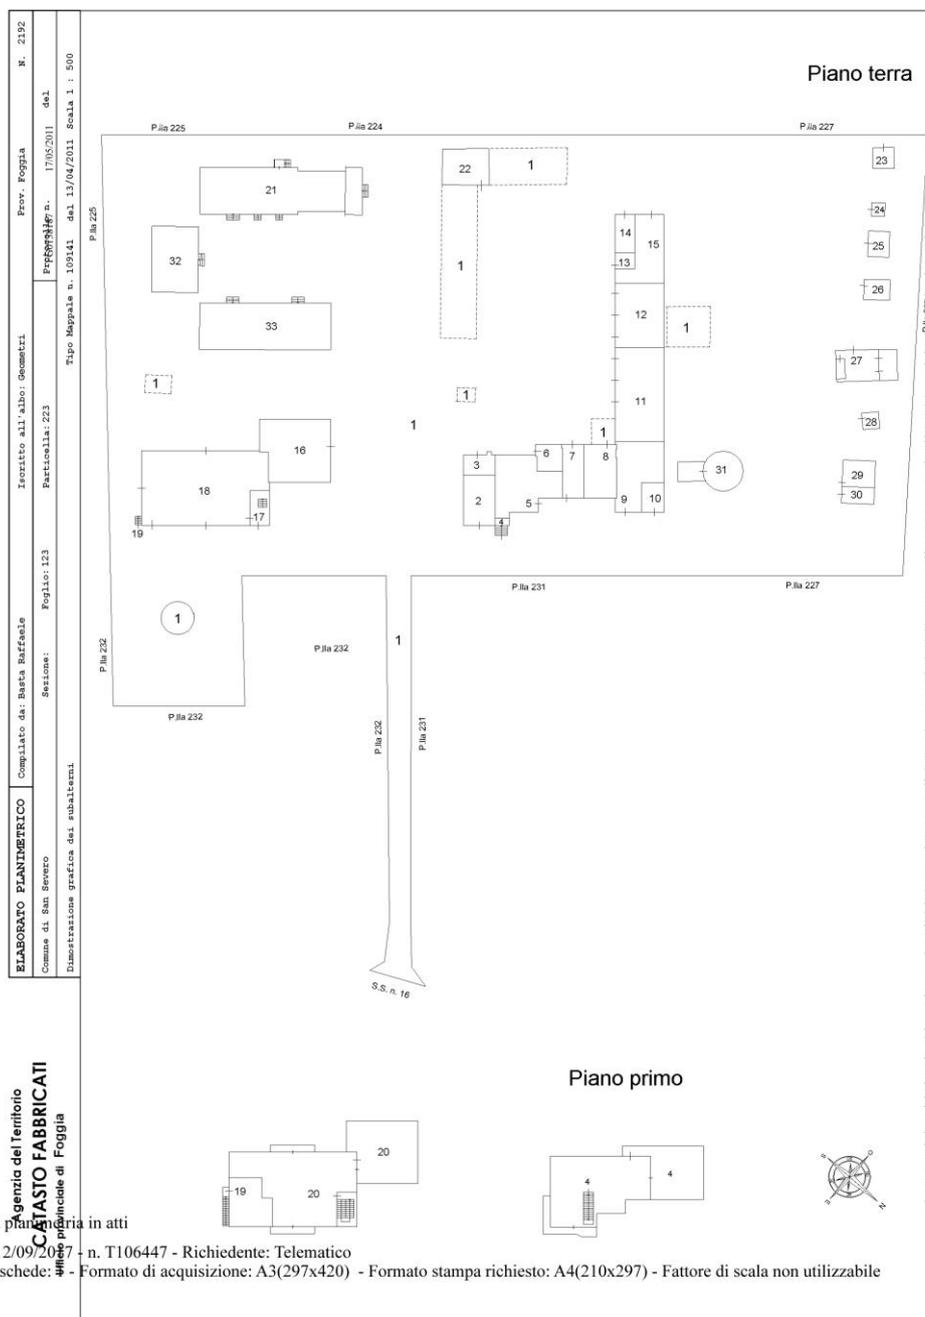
Elaborato planimetrico (Dimostrazione subalterni).
